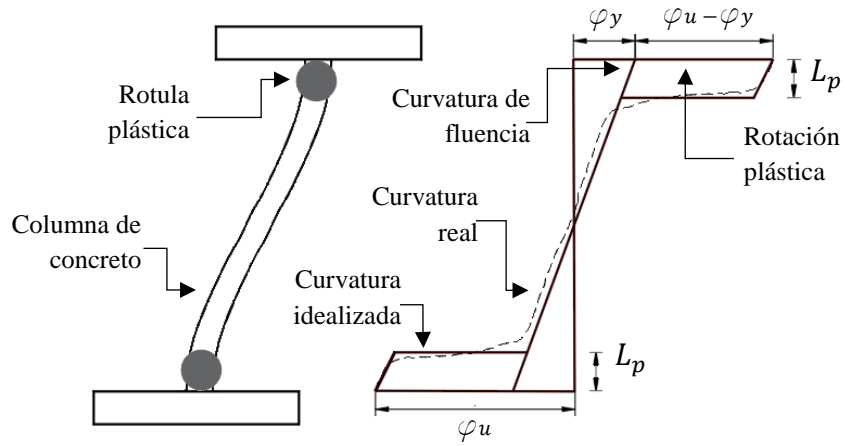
Rotación plástica en columnas de concreto reforzado (adaptado de Caltrans, 2010)
